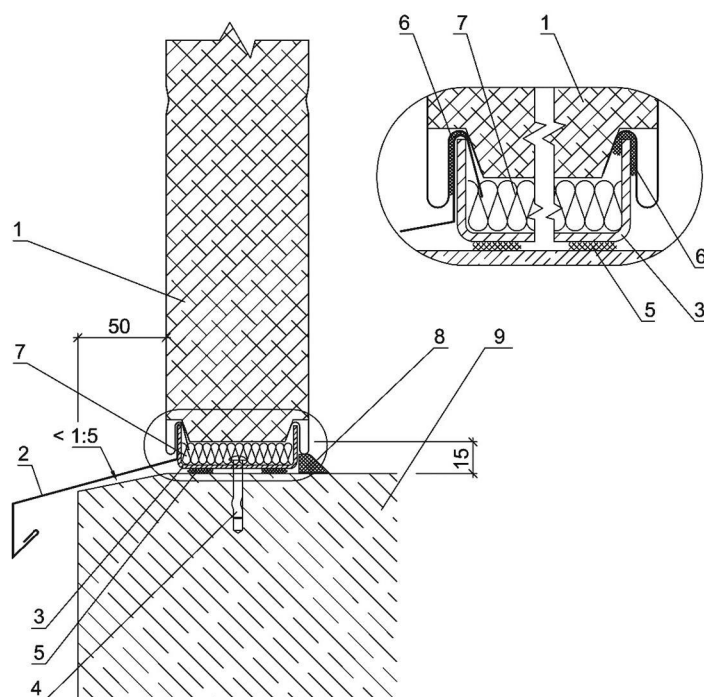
Узел стыка горизонтальных панелей (на железобетонной колонне)
